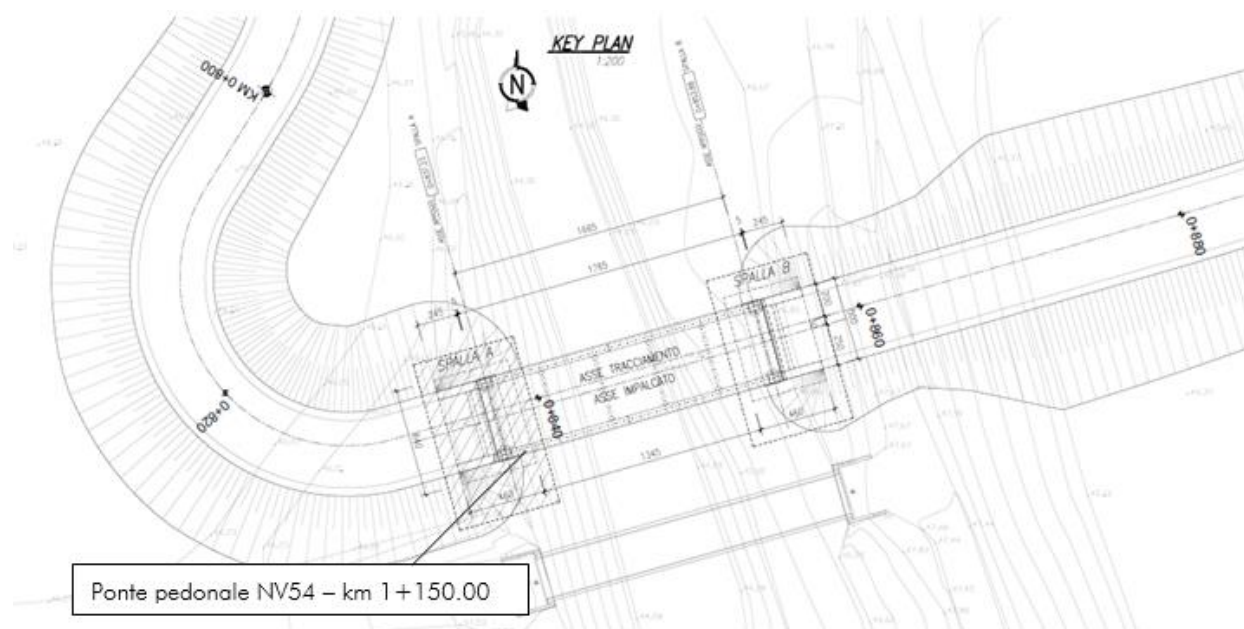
Stralcio planimetrico – Ubicazione Ponte pedonale NV54
